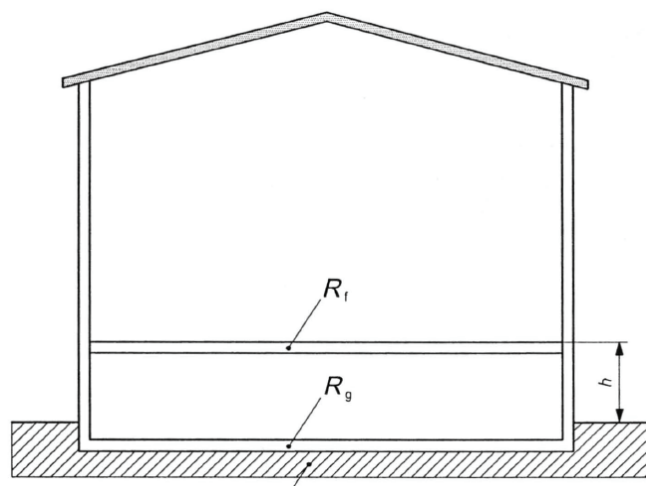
Схема будинку з перекриттям над вентиляльованим приміщенням.
